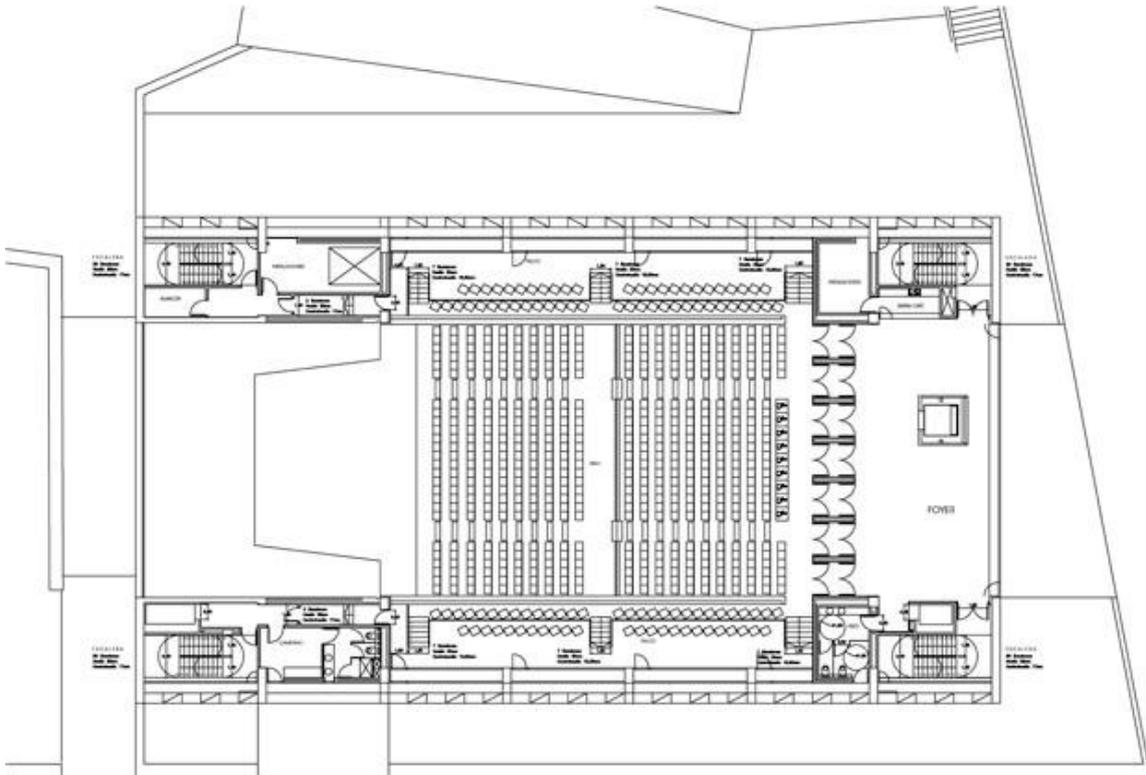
Plano de planta (Gradolí-Sanz Arquitectos)
